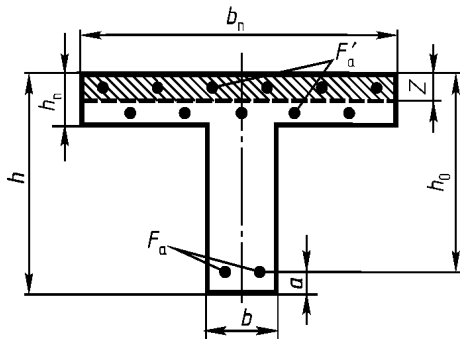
Поперечное сечение таврового железобетонного элемента
